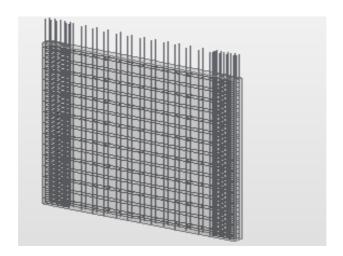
Schéma de ferraillage du voile V_{4.1} de la sous-pente.
